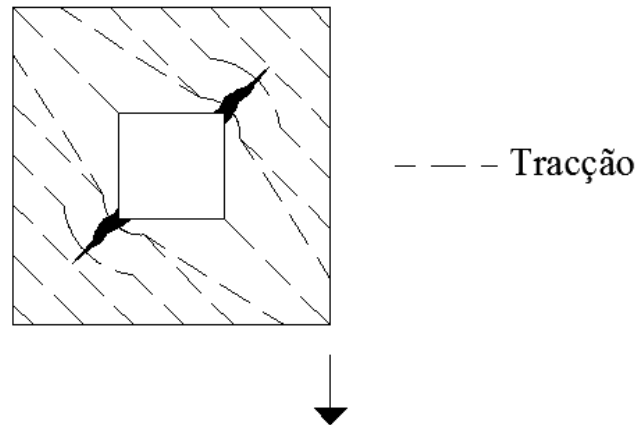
Fissuras diagonais junto das aberturas (Modificado, Ortiz, 1983).
